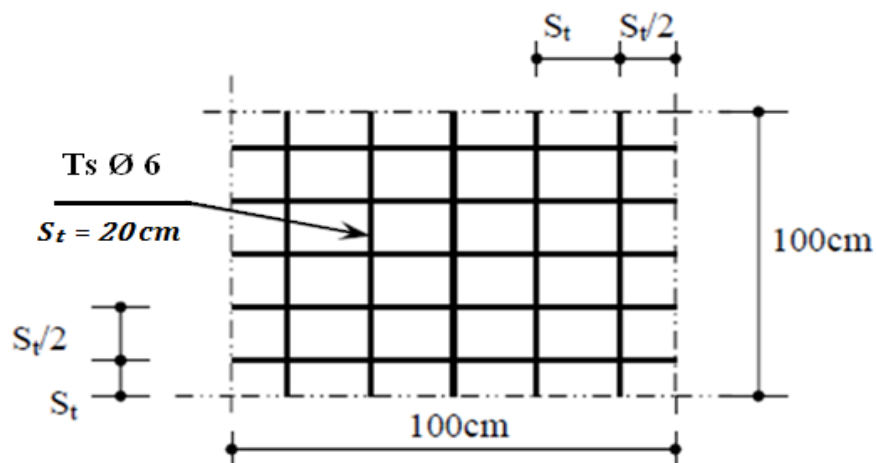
Disposition constructive des armatures de la dalle de compression.
